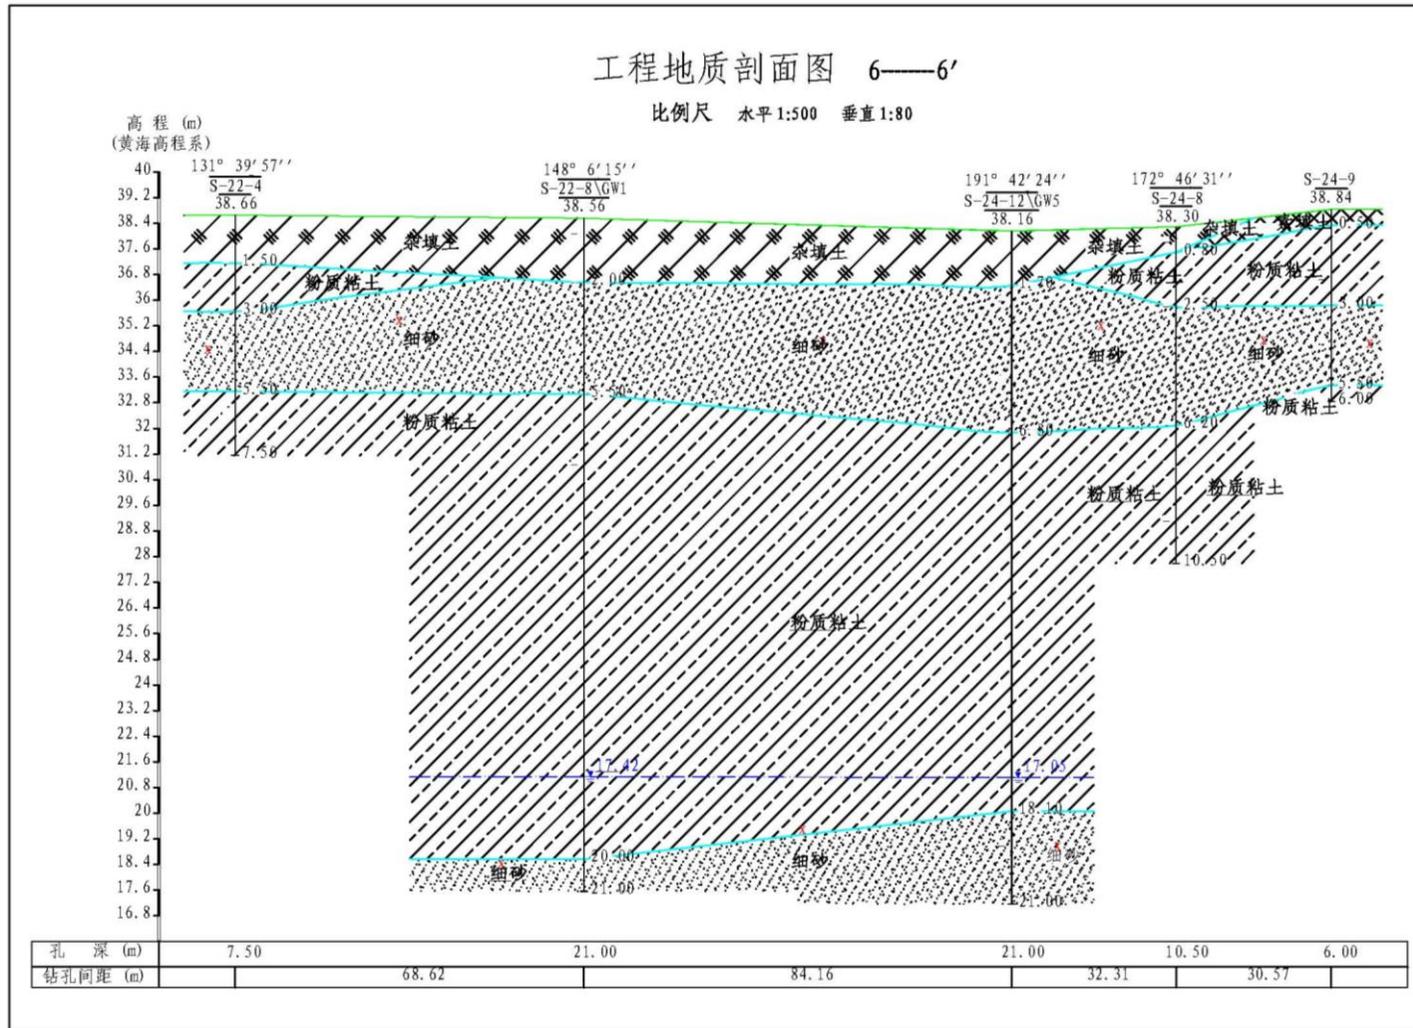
剖面线 6-6'地质剖面图 (纵向)
